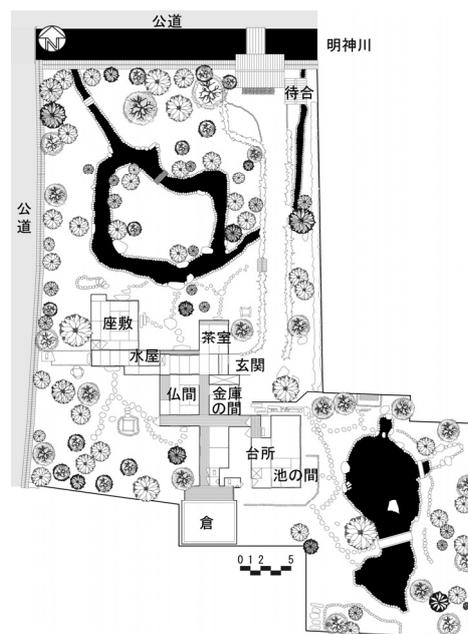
西村家の平面図（『上賀茂 町なみ調査報告』収録の平面図を元に筆者作成）
